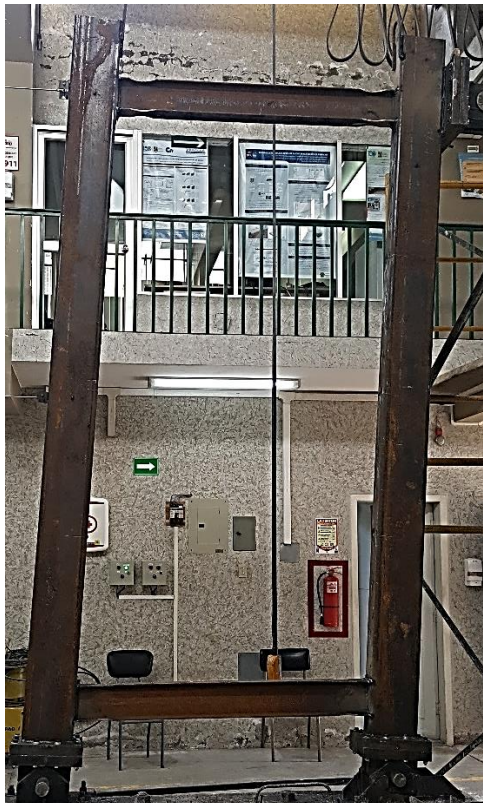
Pórtico y muro SPSW sin rigidizadores.
